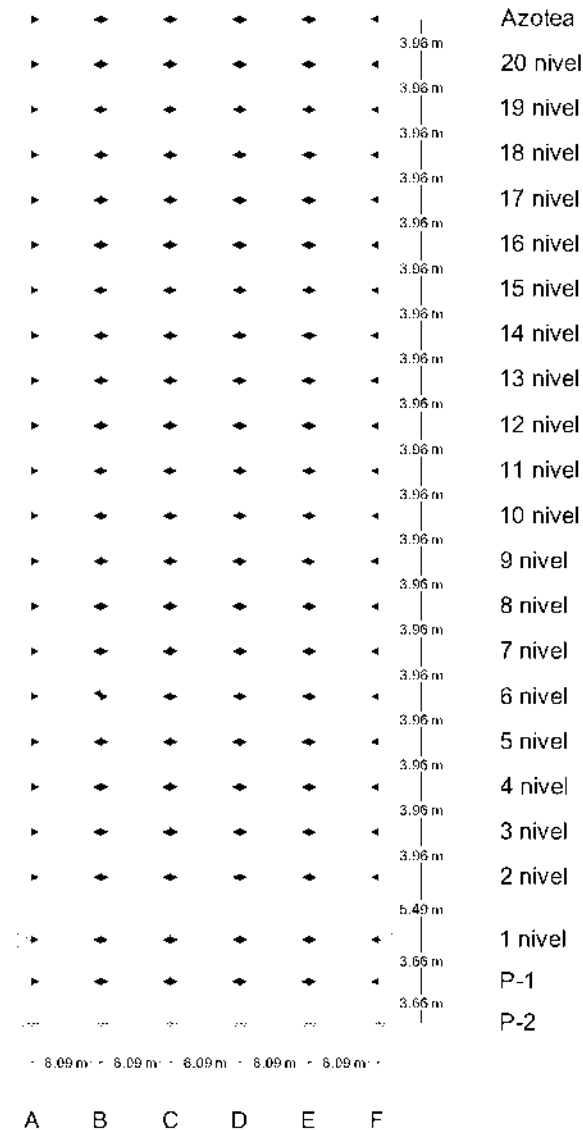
Vista en elevación del edificio de 20 niveles.
